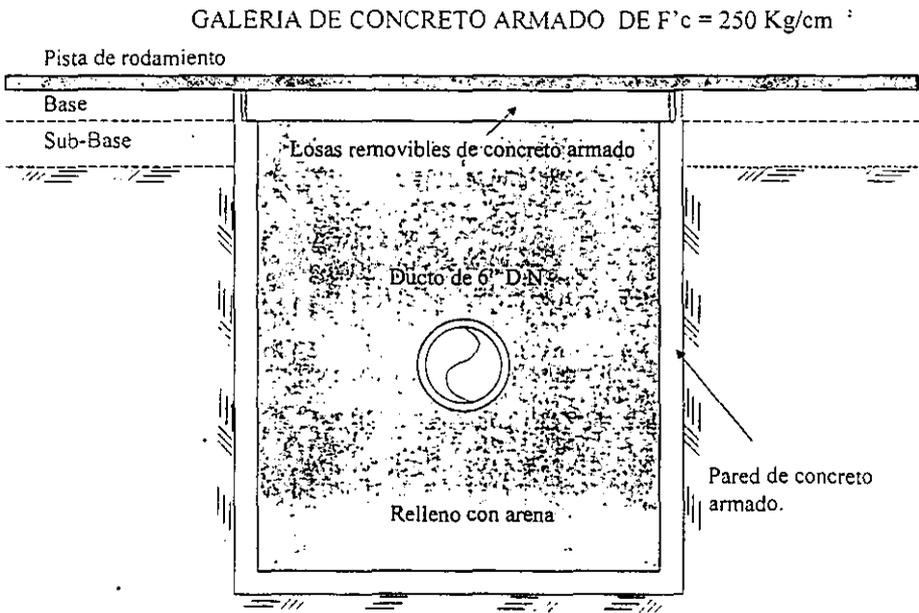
Galería de concreto para protección de ducto en cruces vehiculares.
